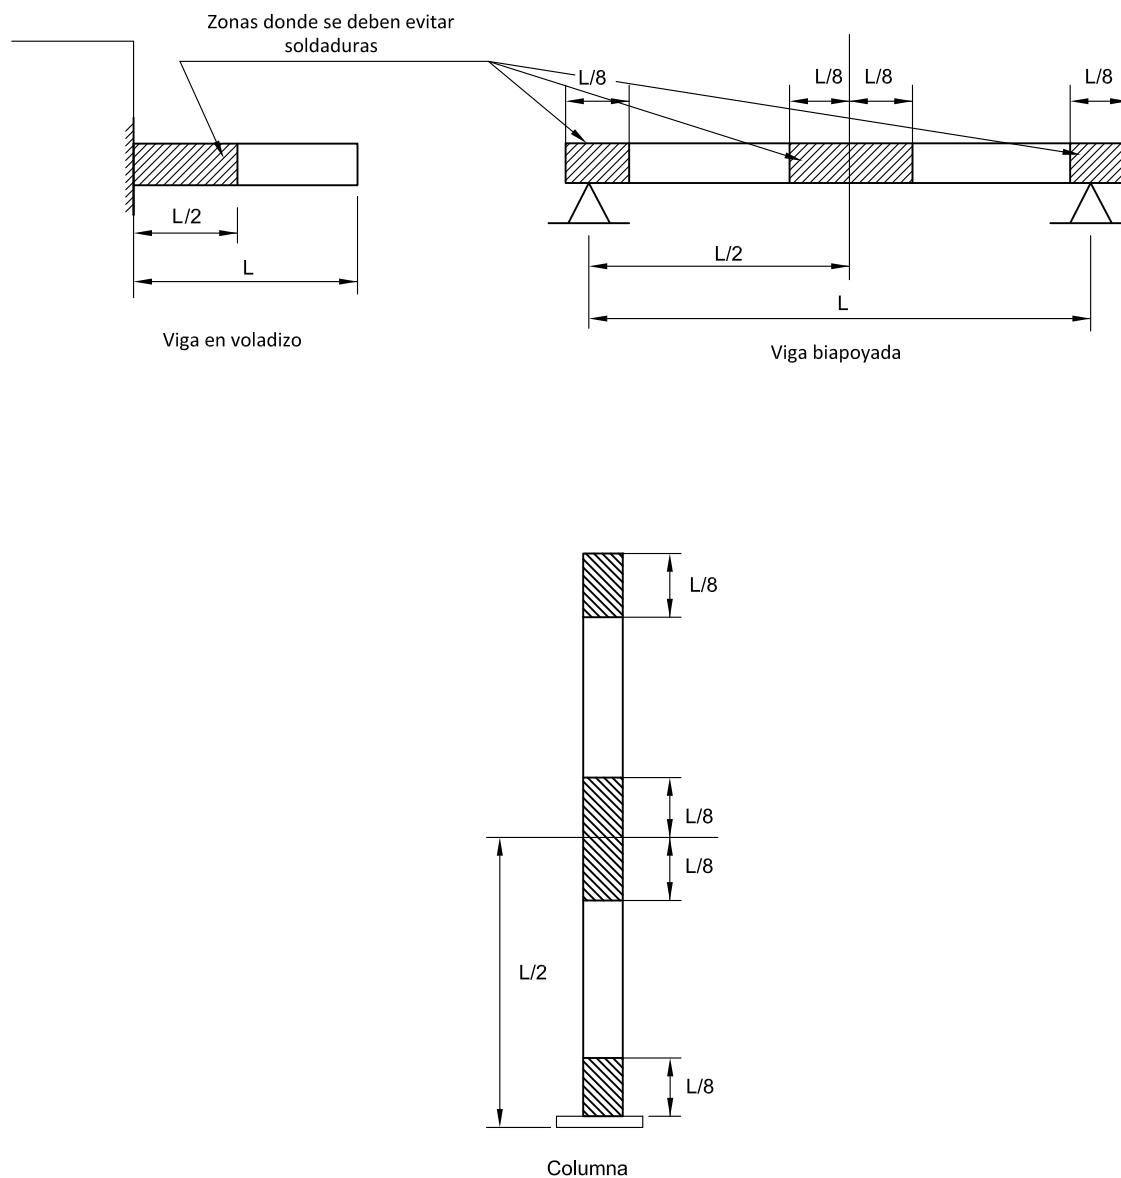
Posición de Soldaduras en Perfiles
